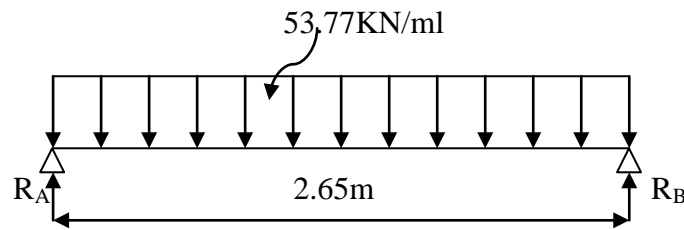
Schéma statique de la poutre palière à l'ELS.
